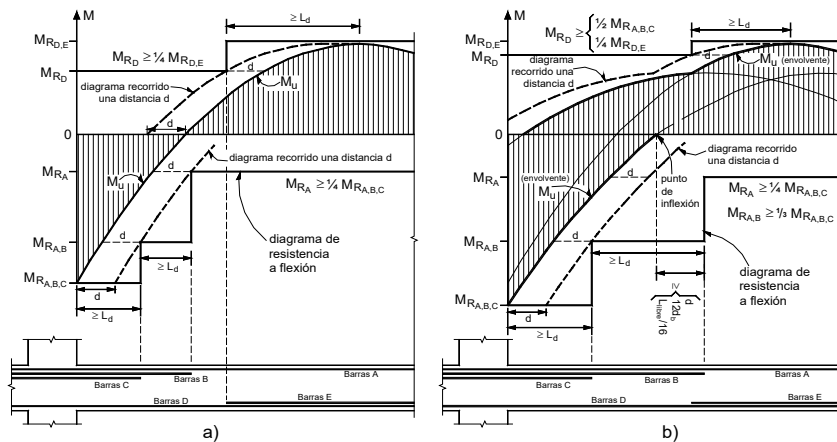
DISPOSICIONES PARA EL CORTE DEL ACERO DE REFUERZO EN VIGAS:
